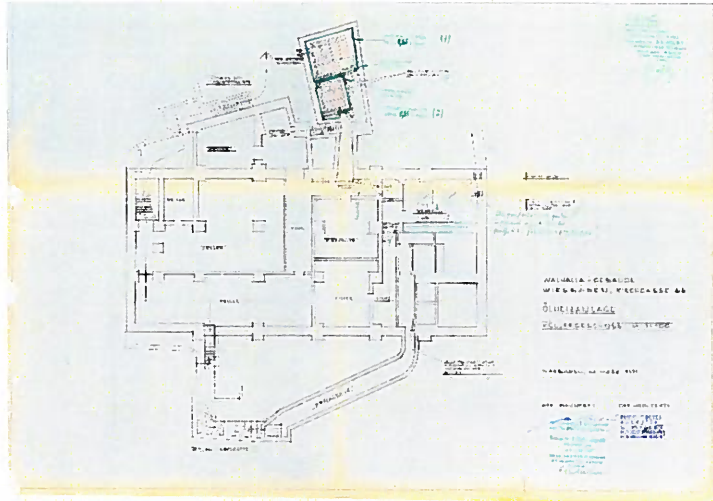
Kellergrundriss Einbau von Heizöltanks 1971, Bauakte Stadt Wiesbaden
